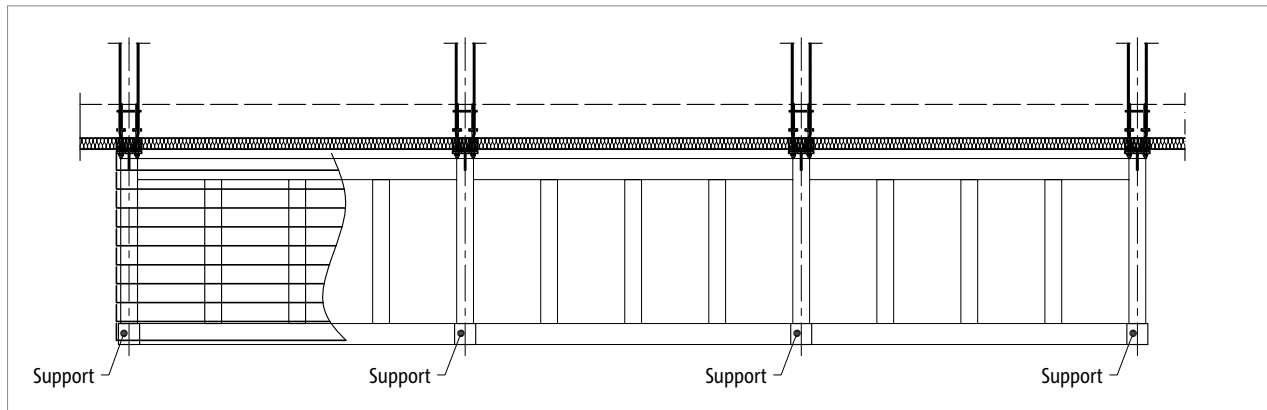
Schöck Isokorb® T type SQ : Balcon avec appuis
